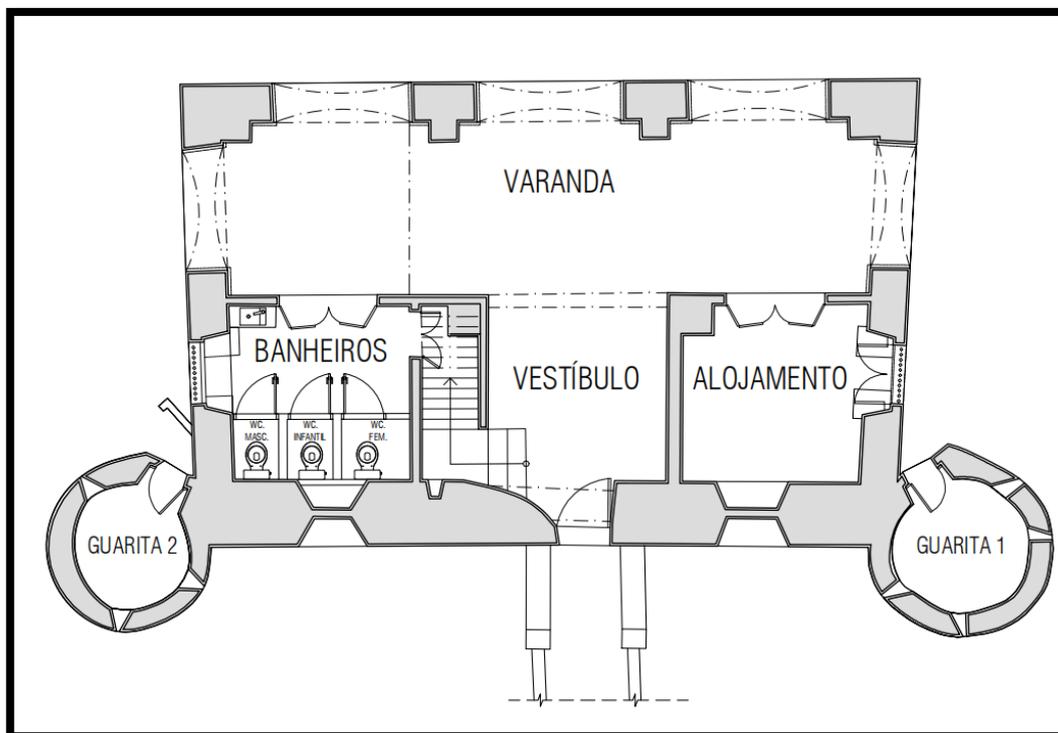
Planta baixa - pavimento térreo – sem escala (Fonte: produção da autora)
